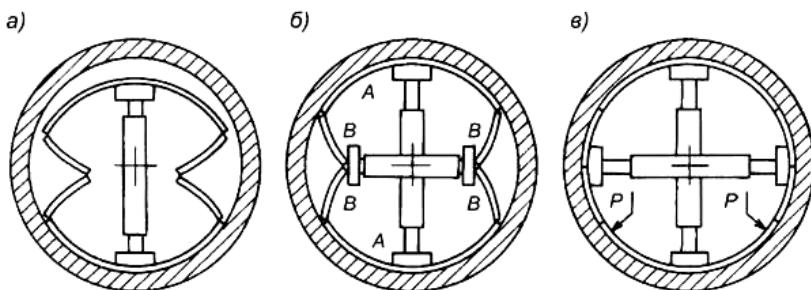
Схема установки шарнирной тонкостенной облицовки Grouting для трубопроводов диаметром 600 – 2 800 мм:
